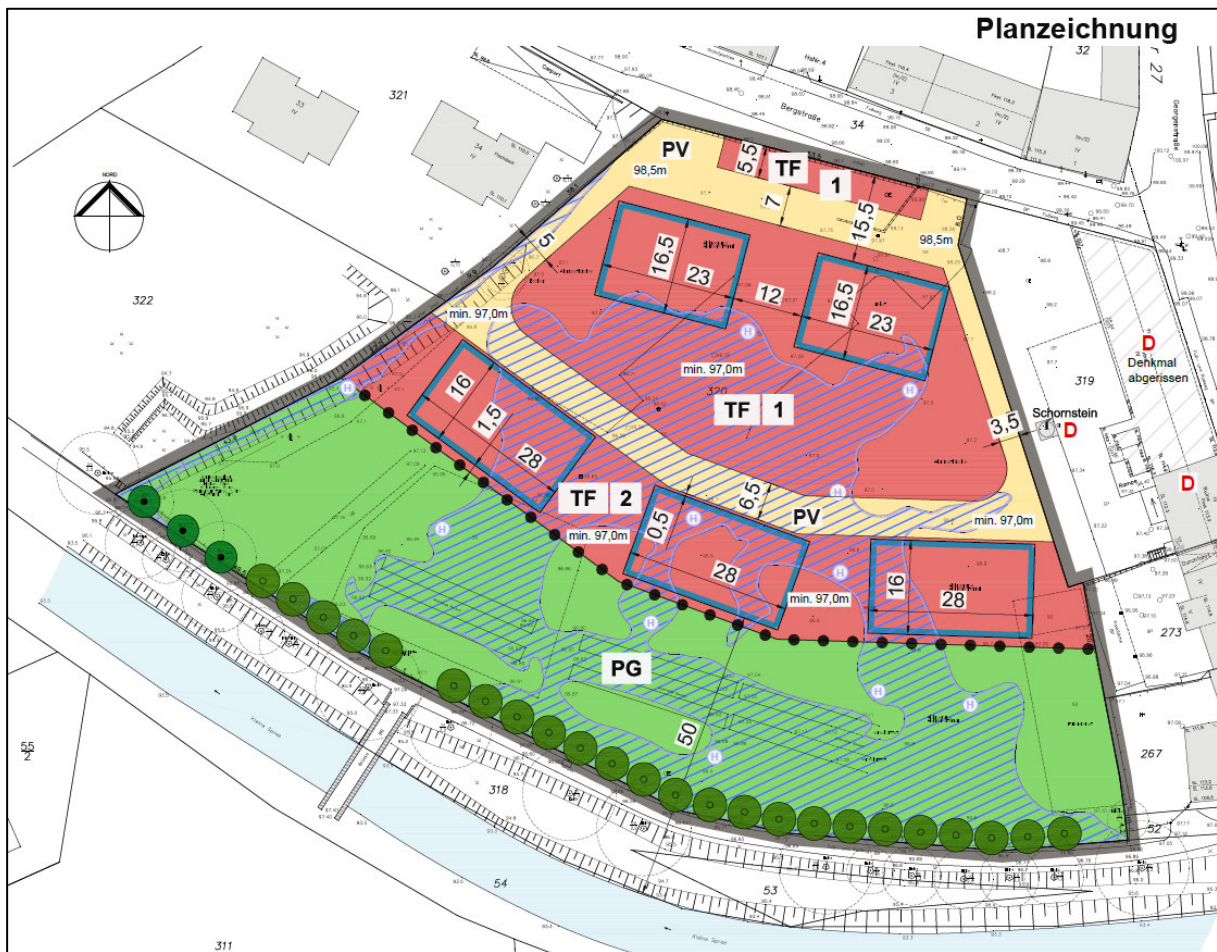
Planzeichnung B-Plan Nr. 104 (Quelle: Planungsbüro Wolff architektur - stadtplanung GbR, Stand: August 2025)
